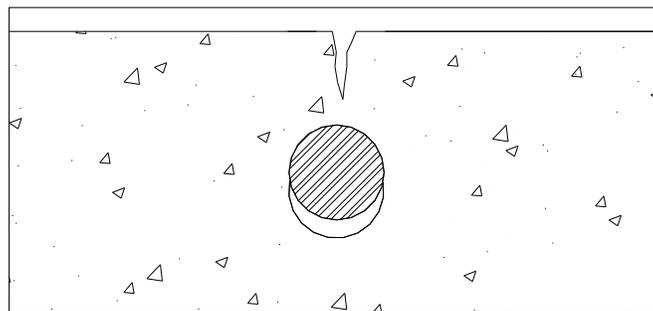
fisura debida al asentamiento plástico
